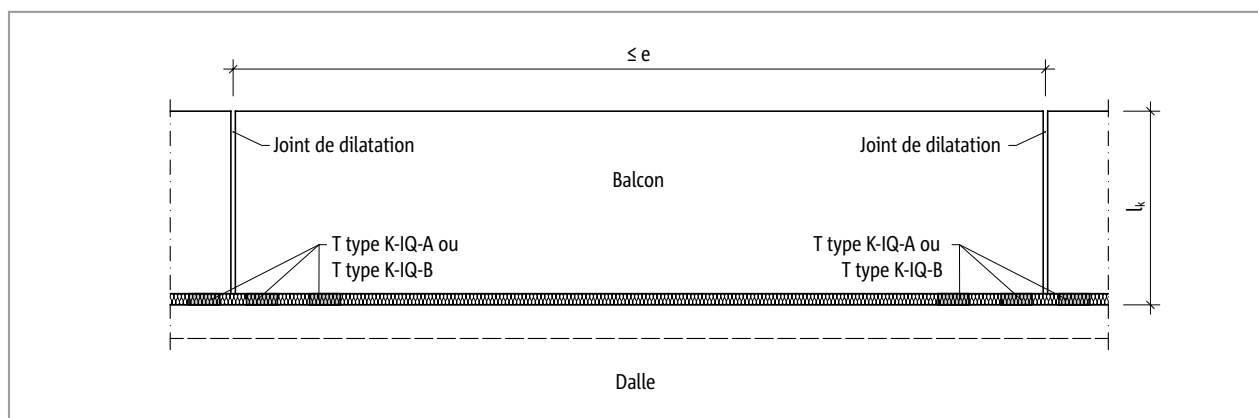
Schöck Isokorb® T type K-IQ : disposition des joints de dilatation
